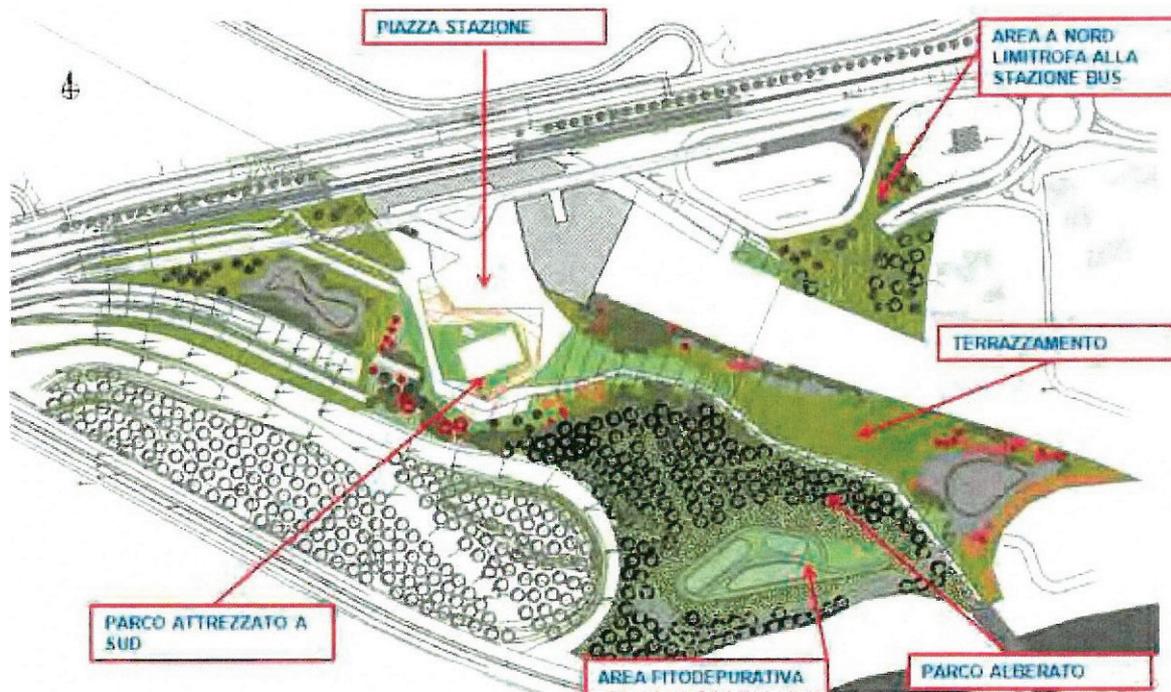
Schema planimetrico delle sistemazioni a verde nell'area della nuova stazione internazionale
